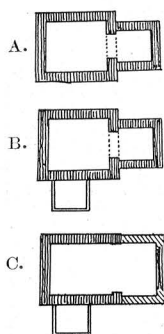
Gillstad. Planutveckling. Grundrissentwcklung.
